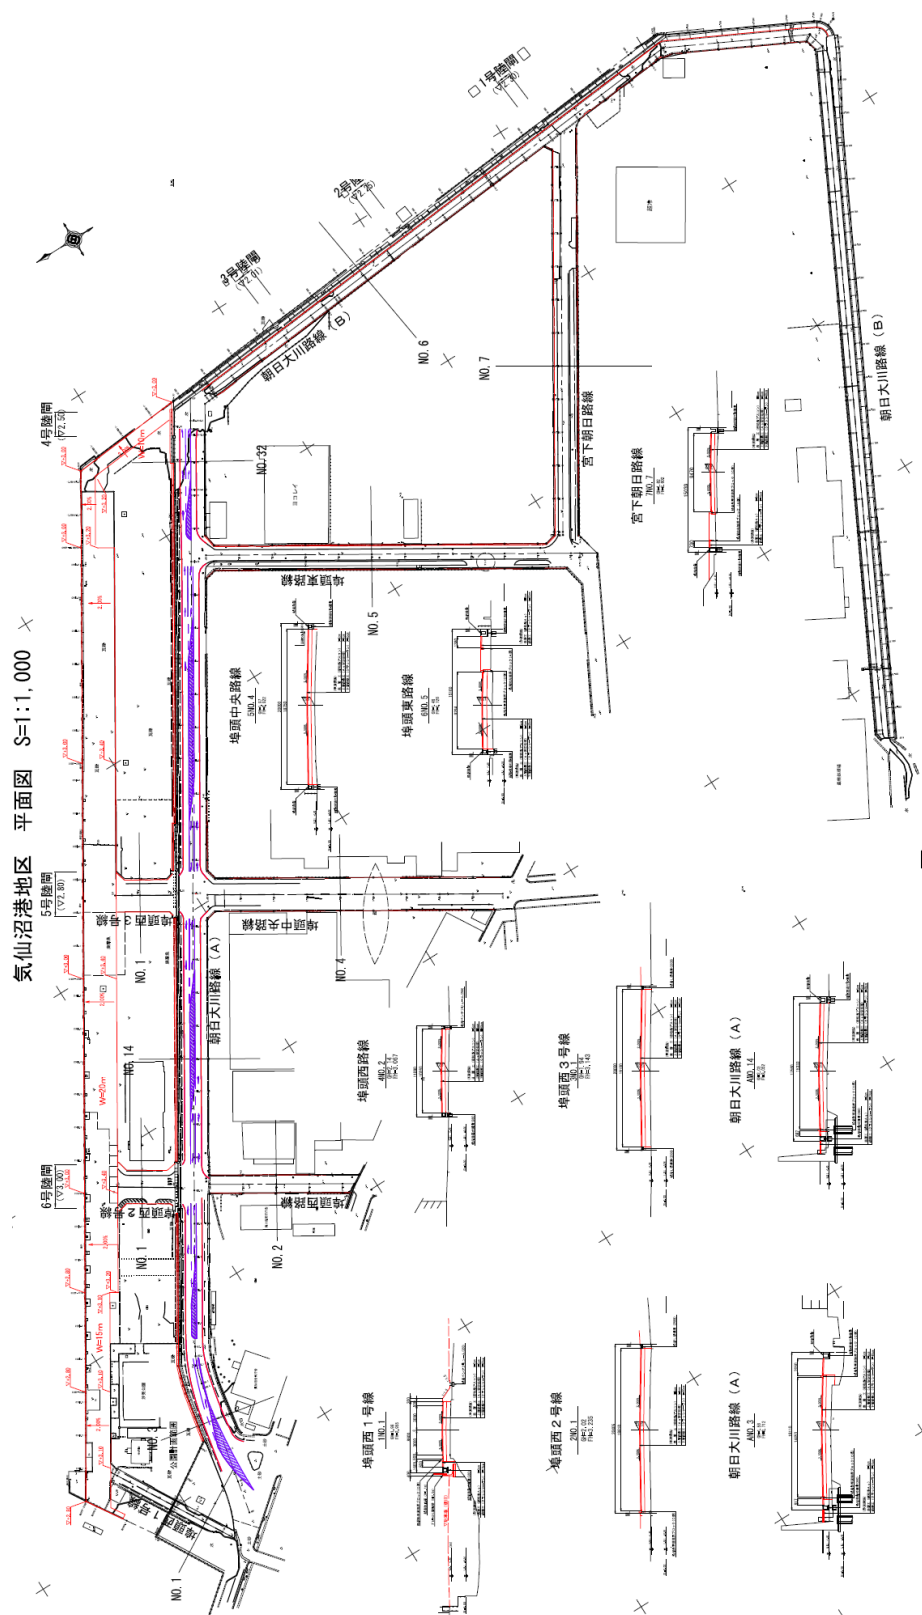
No.2 埠頭西 1 号線平面図 (復旧後)
